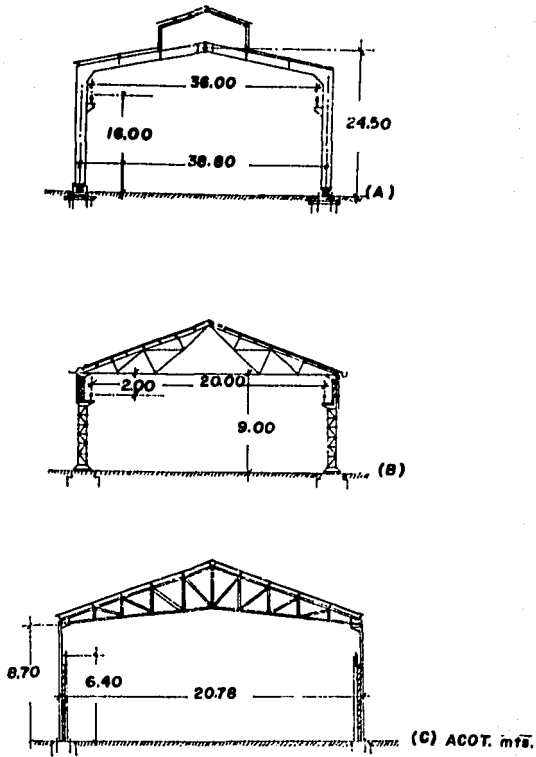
Secciones transversales típicas de naves industriales estructuradas en acero.
